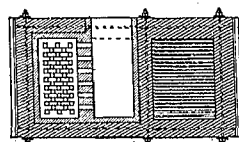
Grundriss i. d. Höhe E-F.
